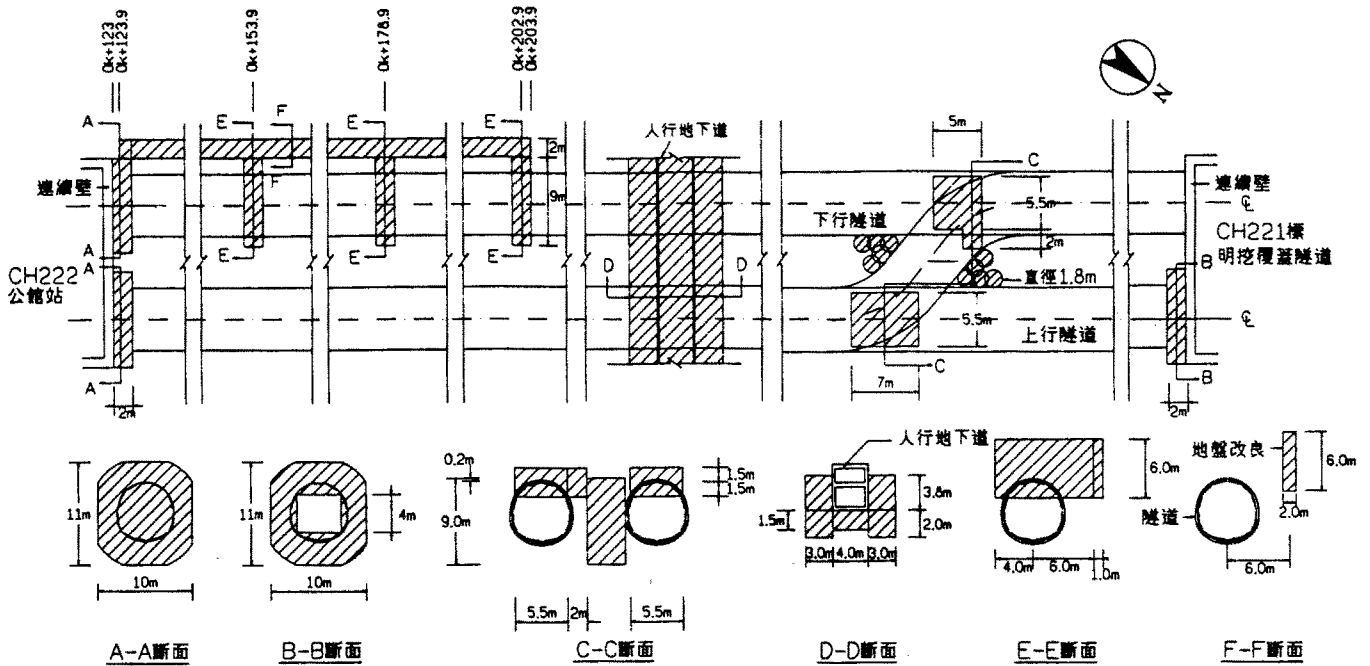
新奧工法隧道地盤改良平面配置與剖面圖
